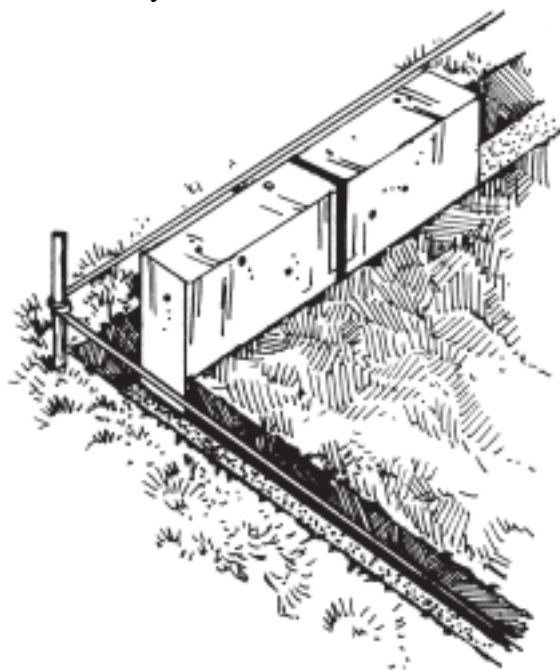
Тип укладки на бетонной стяжке и песчаной подушке
